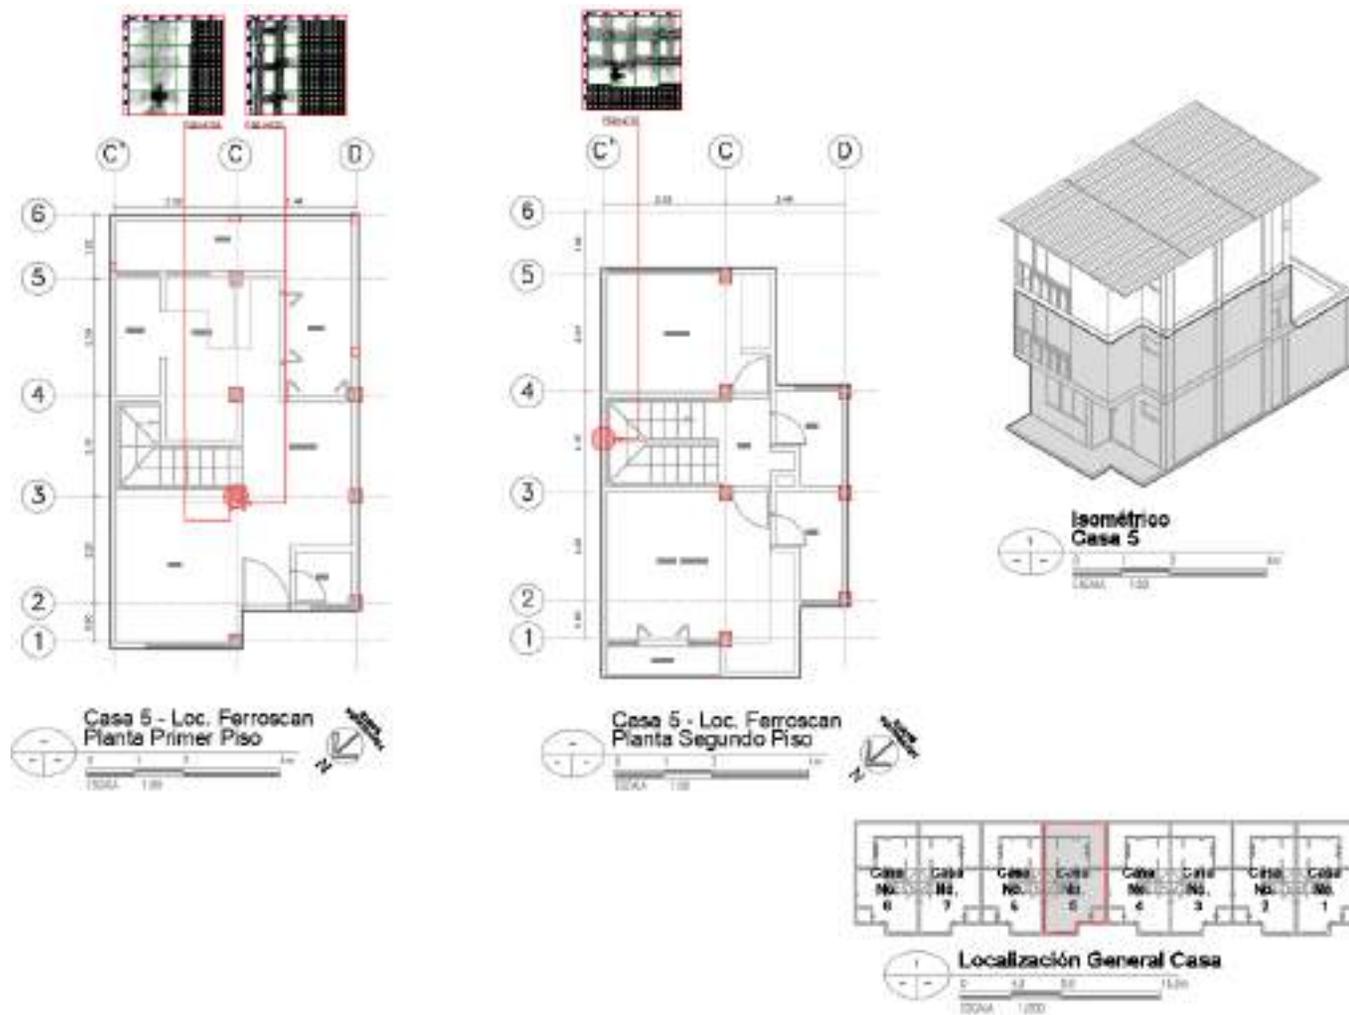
Localización lecturas de ferroskan – Casa No. 5 primer piso (Columna y Viga).
